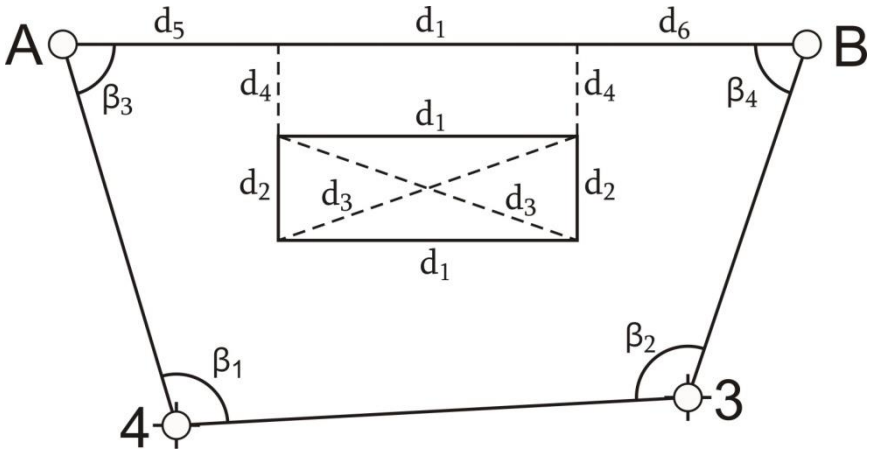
Розмічувальне креслення червоної лінії забудови і будівлі
